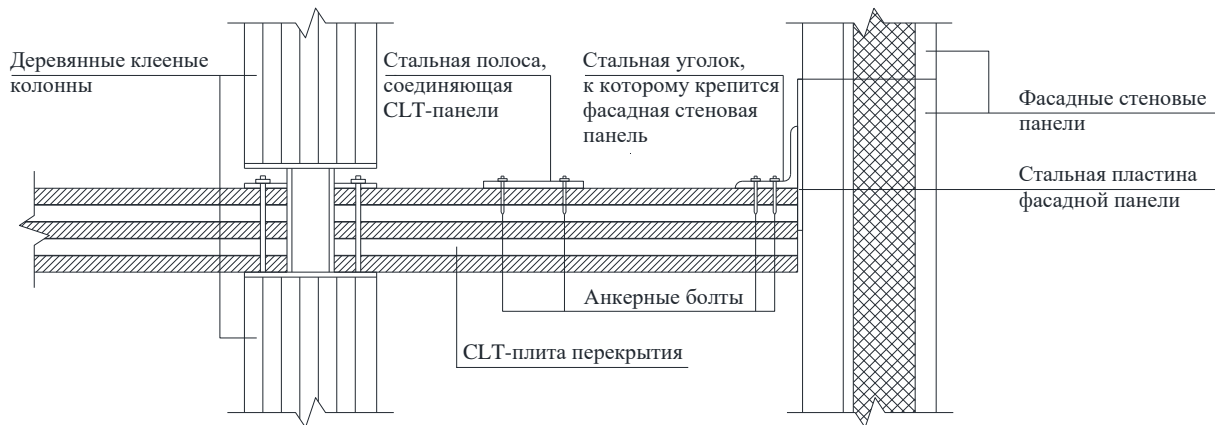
Узел крепления конструкций деревянного каркасного здания
